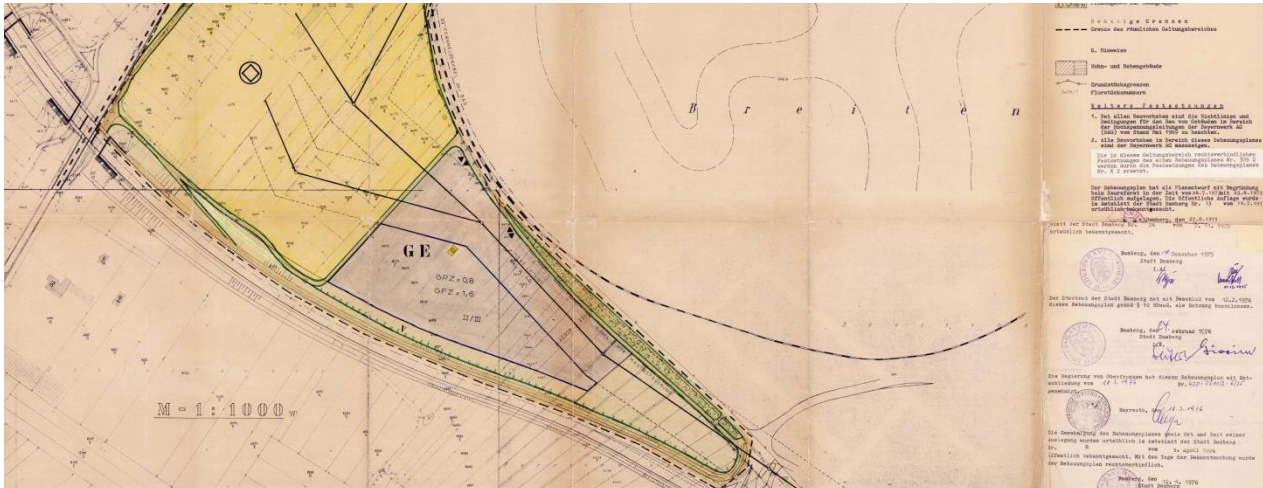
Ausschnitt – Bebauungsplan Nr. K 2 (Gewerbegebiet zw. Bayernwerk, Berliner Ring, Gundelsheimer Straße), 1976
